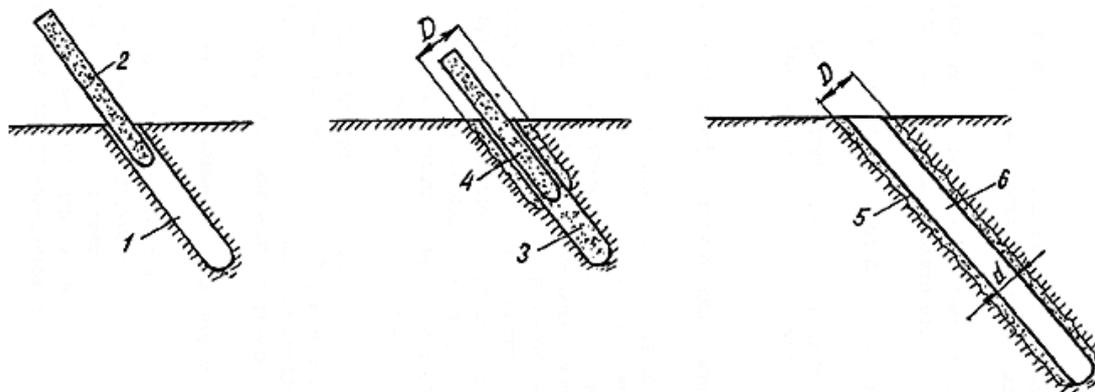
Схема изготовления щебеночной сваи: 1 – скважина; 2 – пневмопробойник; 3 – щебень (гравий); 4 – участок сваи; 5 – готовая свая; 6 – внутренняя полость сваи
